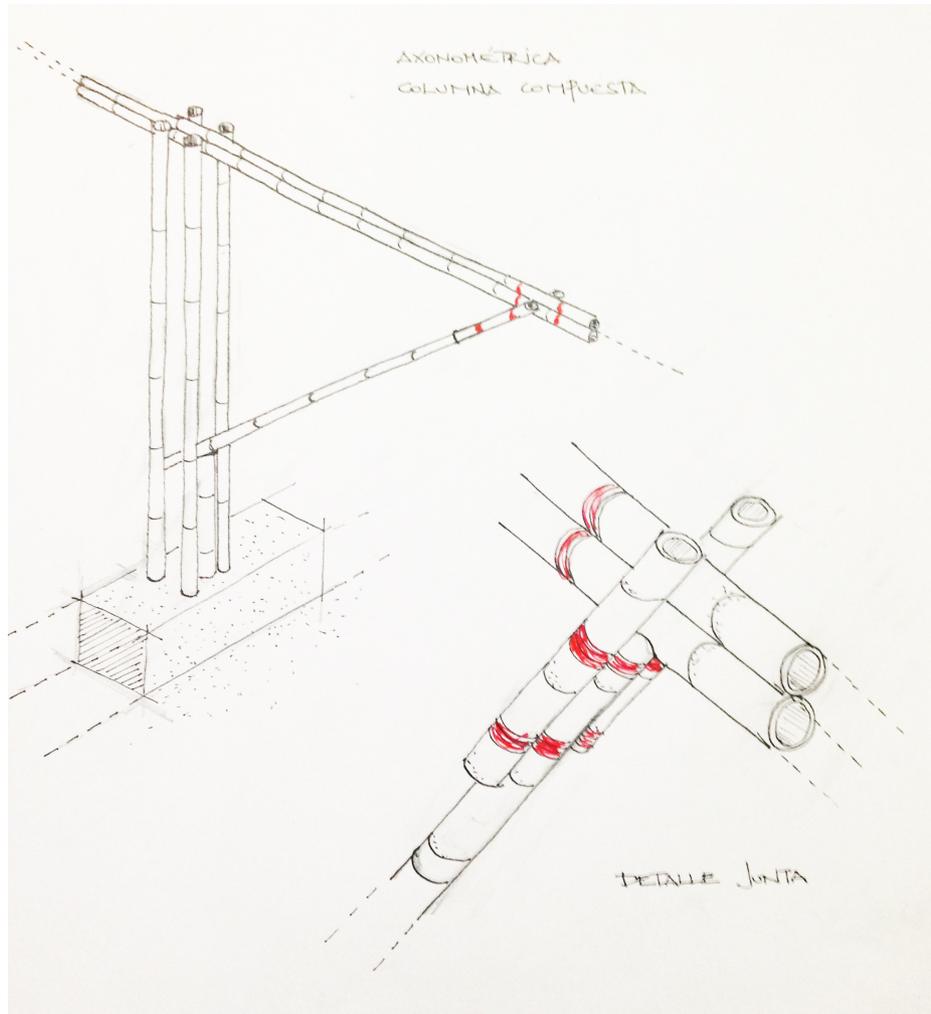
Boceto en el cual se muestra el armado y encuentro de las columnas con las vigas en las aulas de planta alta. (Fuente: Elaboración Propia)
